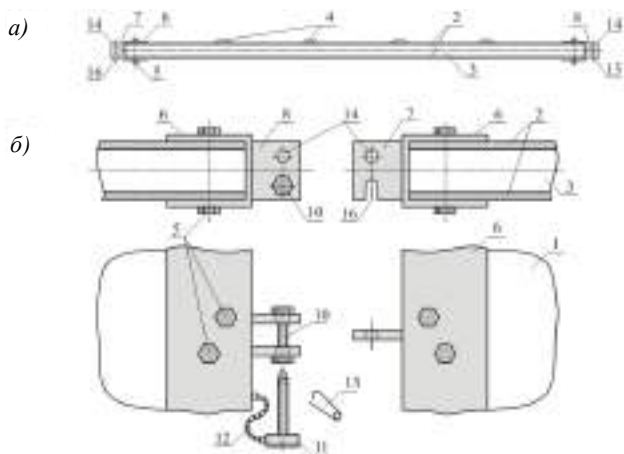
Конструкция сборно-разборного дорожного настила:
